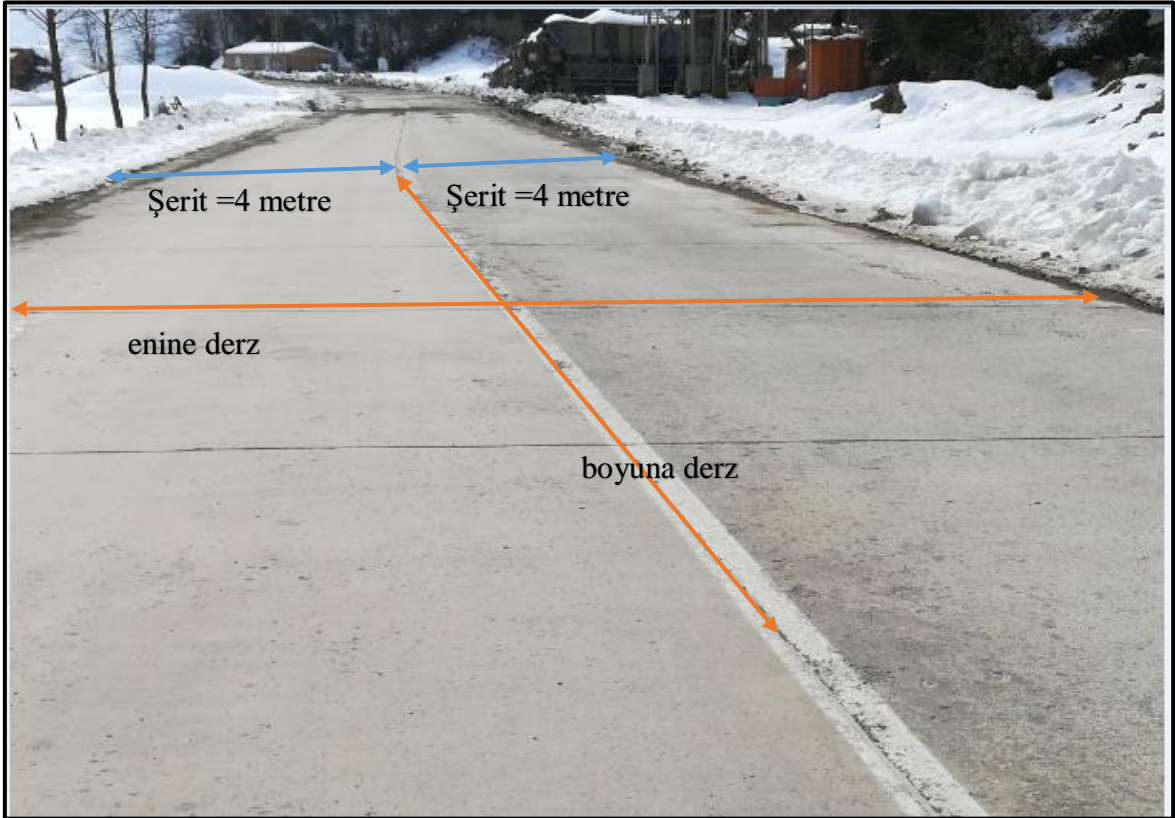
Tonya-Çayırıcı-Kalınçam beton yolu başlangıç tabelasından görünüm
